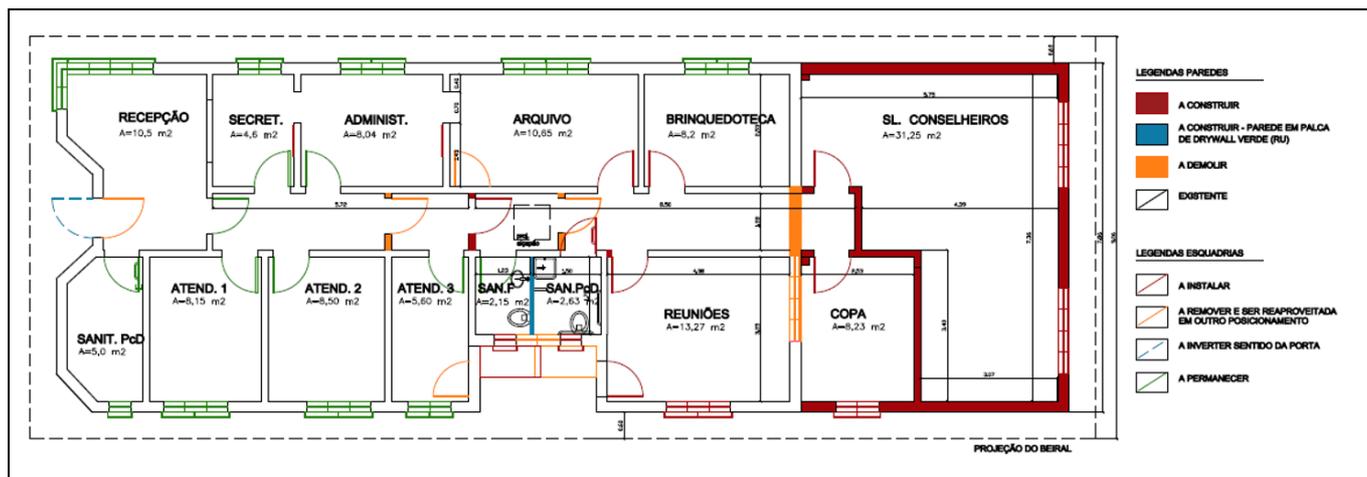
Conselho Tutelar Microrregião 3 – planta baixa.
